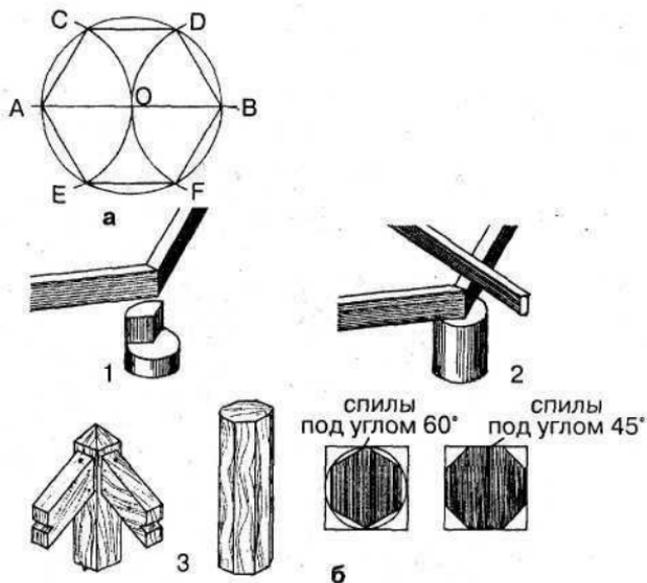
Элементы постройки шестигранной беседки: а — способ разметки шестиугольника; б — виды креплений: 1 — крепление балок на боковых опорах; 2 — крепление балок, поддерживающих ребра крыши; 3 — крепление стропил к центральному столбу
